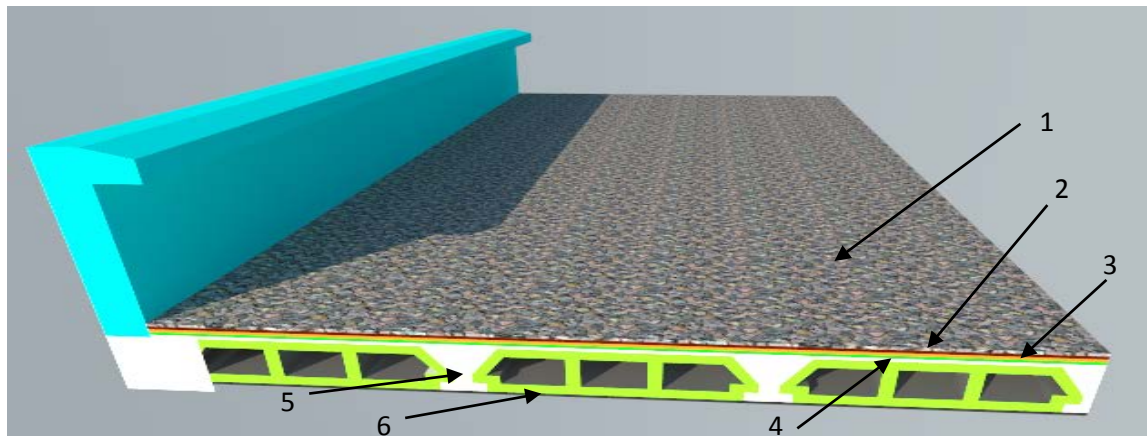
Détail des constituants du plancher terrasse inaccessible.
